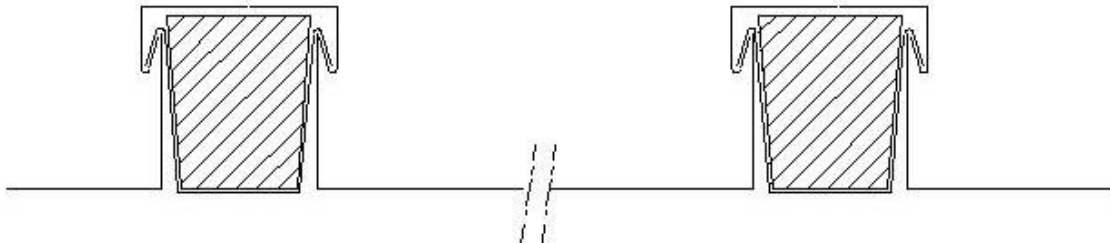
Roefdakconstructie met vaste en schuivende klangconstructie
